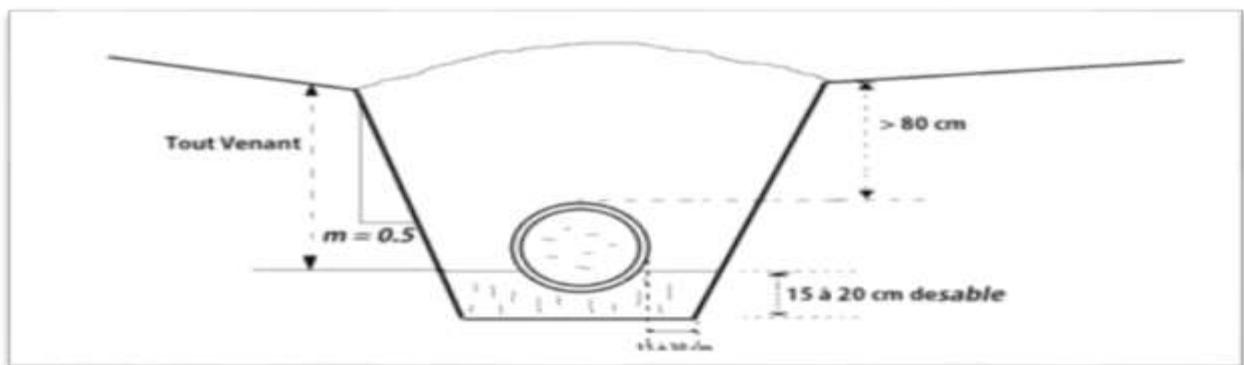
Pose de conduite en tranché dans un terrain ordinaire
